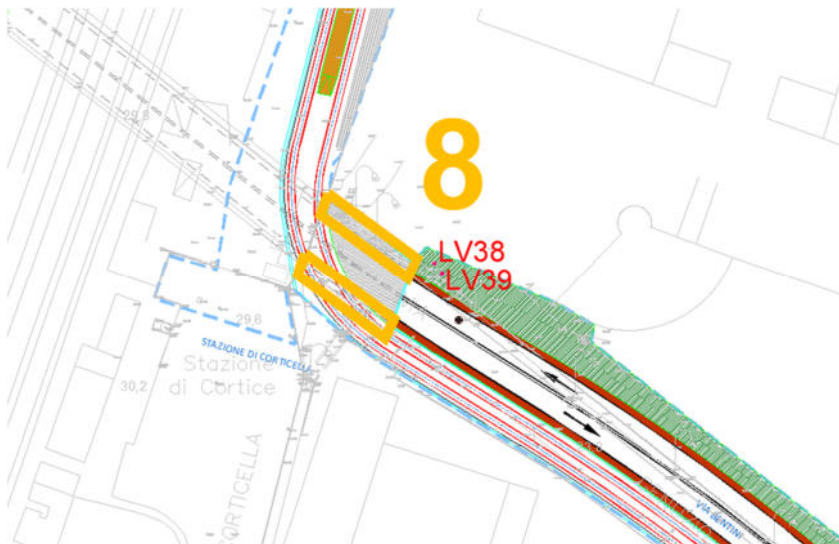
stralcio planimetrico con la localizzazione dei sondaggi LV38-LV39
